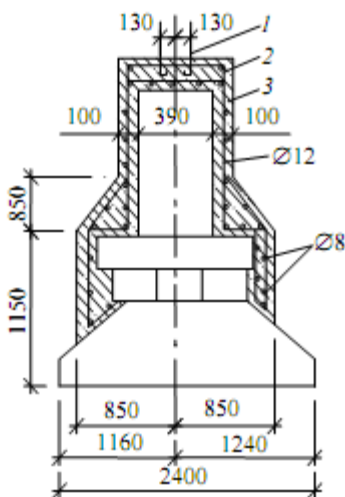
Варіант посилення залізобетонною обоймою збірного окремого фундаменту:
